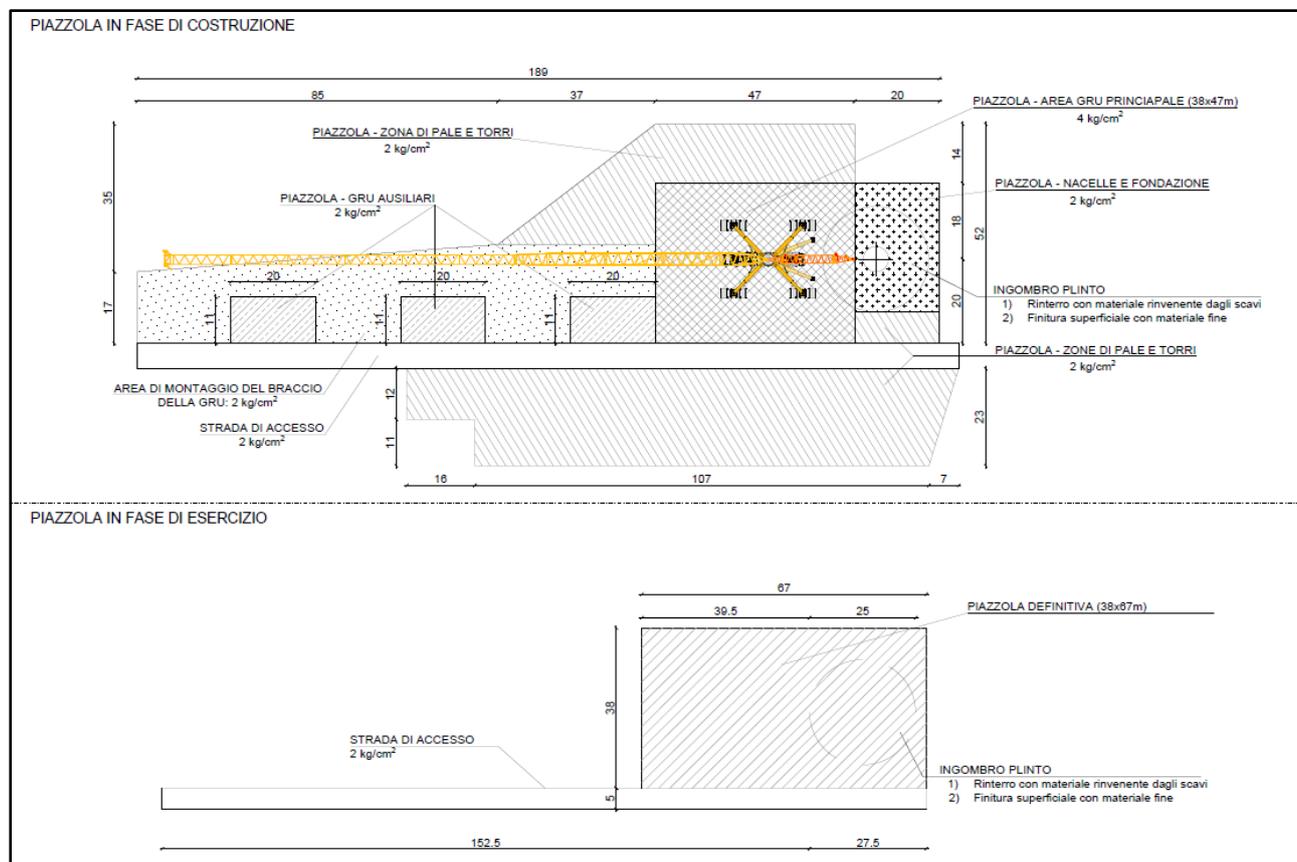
Planimetria piazzola tipo per la fase di installazione e fase di esercizio e manutenzione
